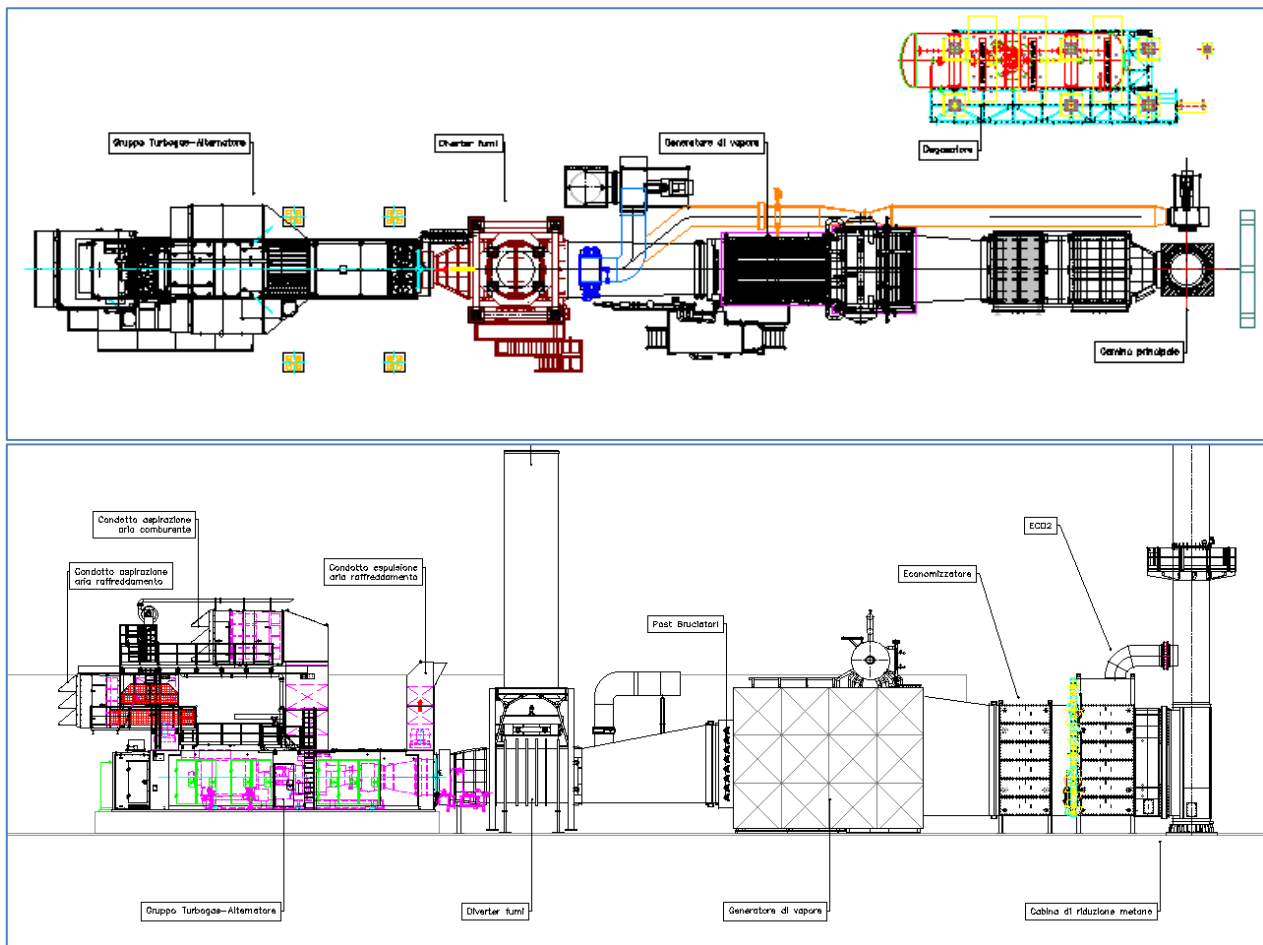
Pianta e prospetto dell'impianto di nuova installazione
